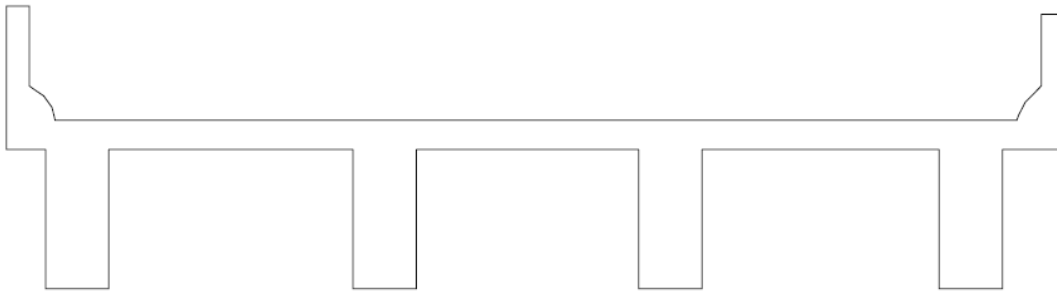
Sección transversal de puente con vigas Te de concreto reforzado colado in situ (AASHTO, 2007).
